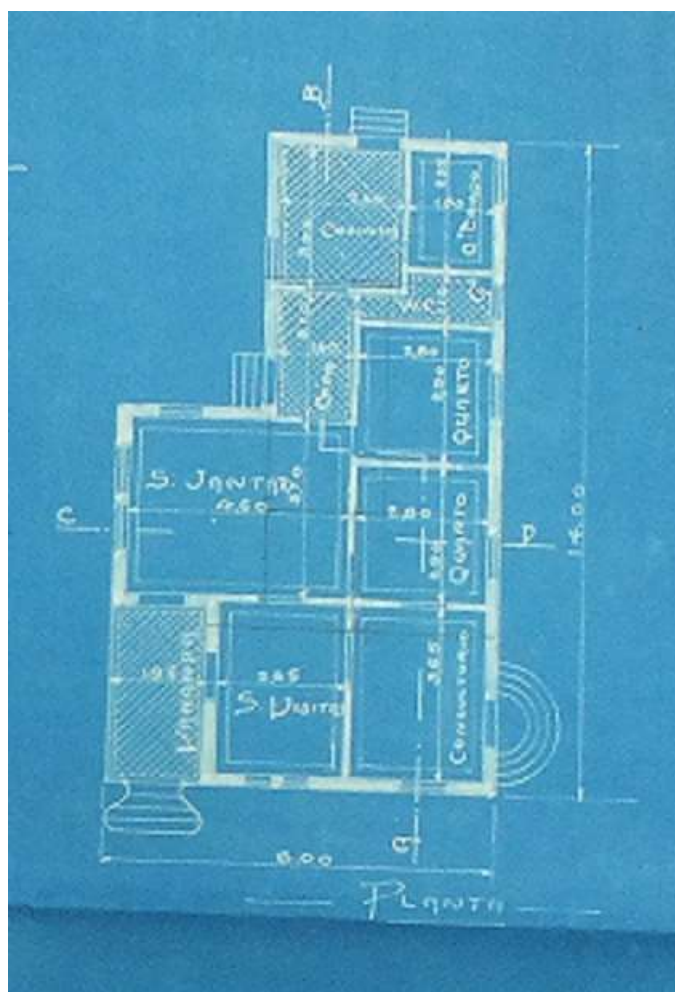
Detalhe da Planta de Residência de 1912 com Banheiro
